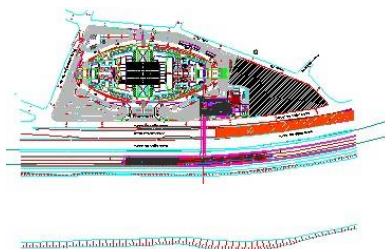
Planta do andar térreo do conjunto comercial Brookfield Towers.
